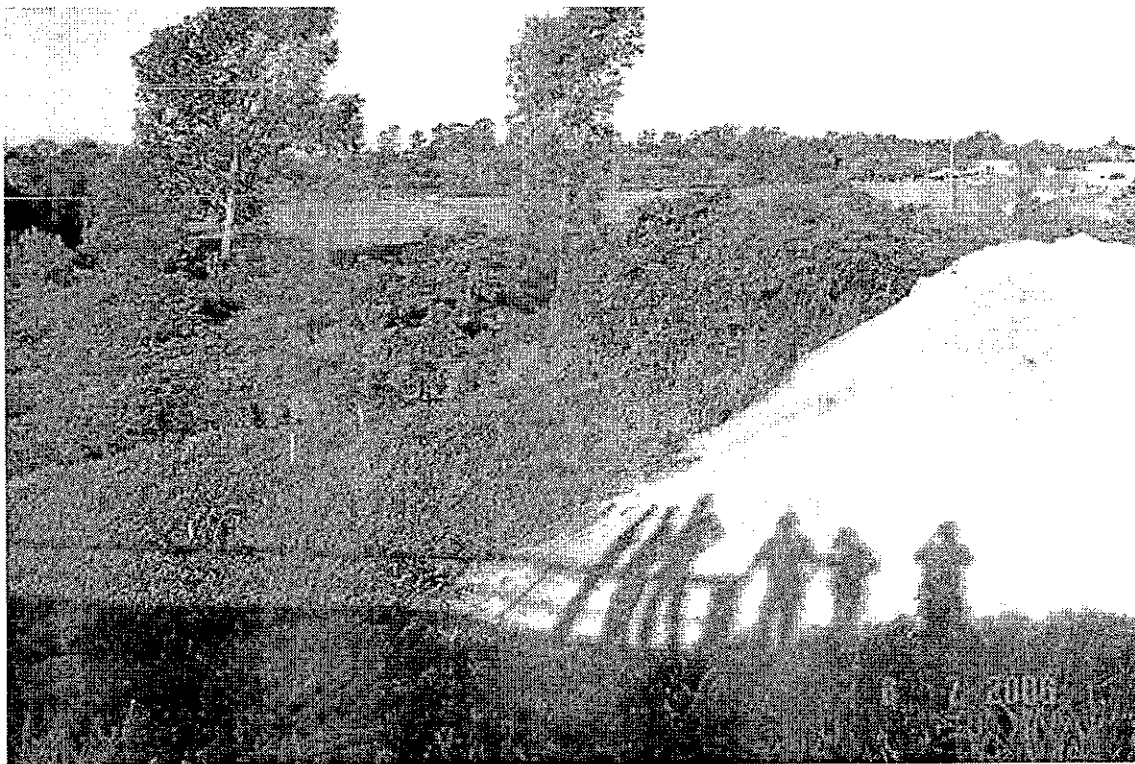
Vista do talude em que foi recomendado a instalação de manta de contenção.
